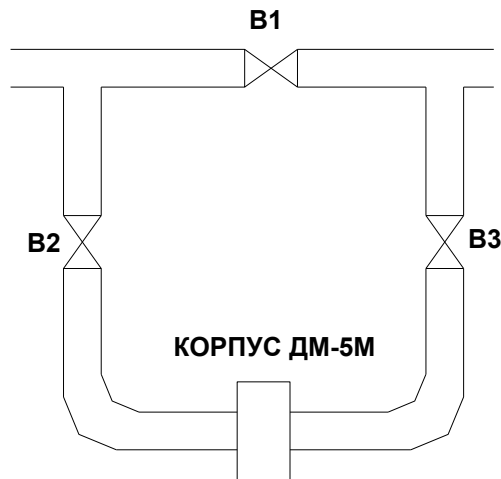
Схема врезки арматуры ДМ-5М на обводном трубопроводе
